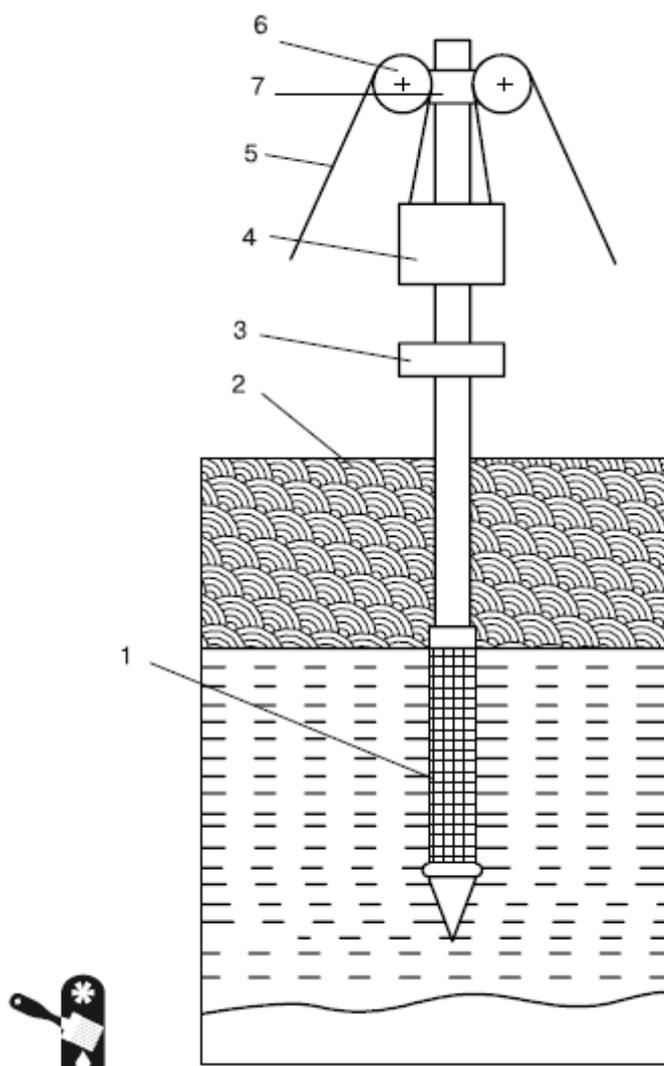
Забивка абиссинского колодца: 1 – сетчатый фильтр; 2 – труба; 3 – первый хомут (подбабок); 4 – баба; 5 – веревка; 6 – блок; 7 – второй хомут
